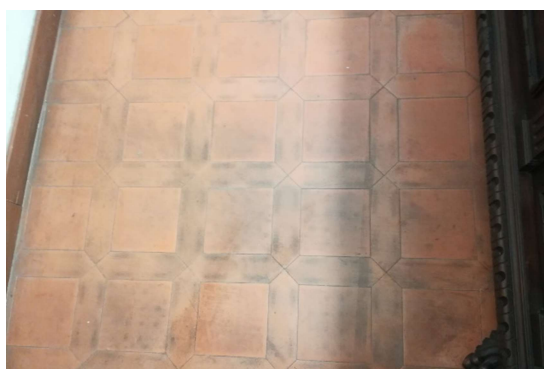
Palazzo Ossoli – pavimentazione in cotto ambiente C5 piano terra
